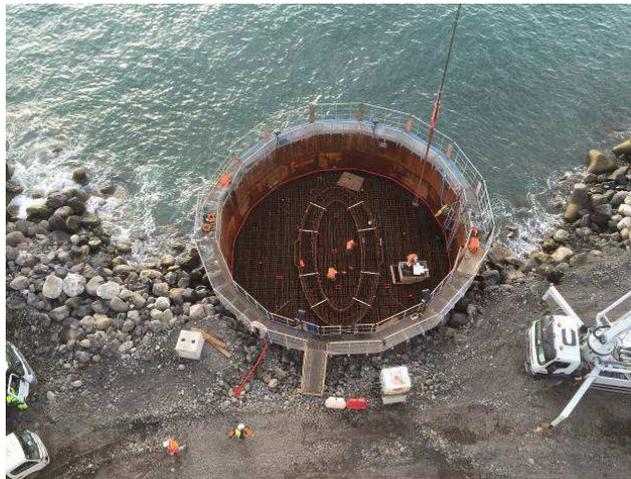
Ferrailage de la semelle de la pile P2 au sein d'une virole
